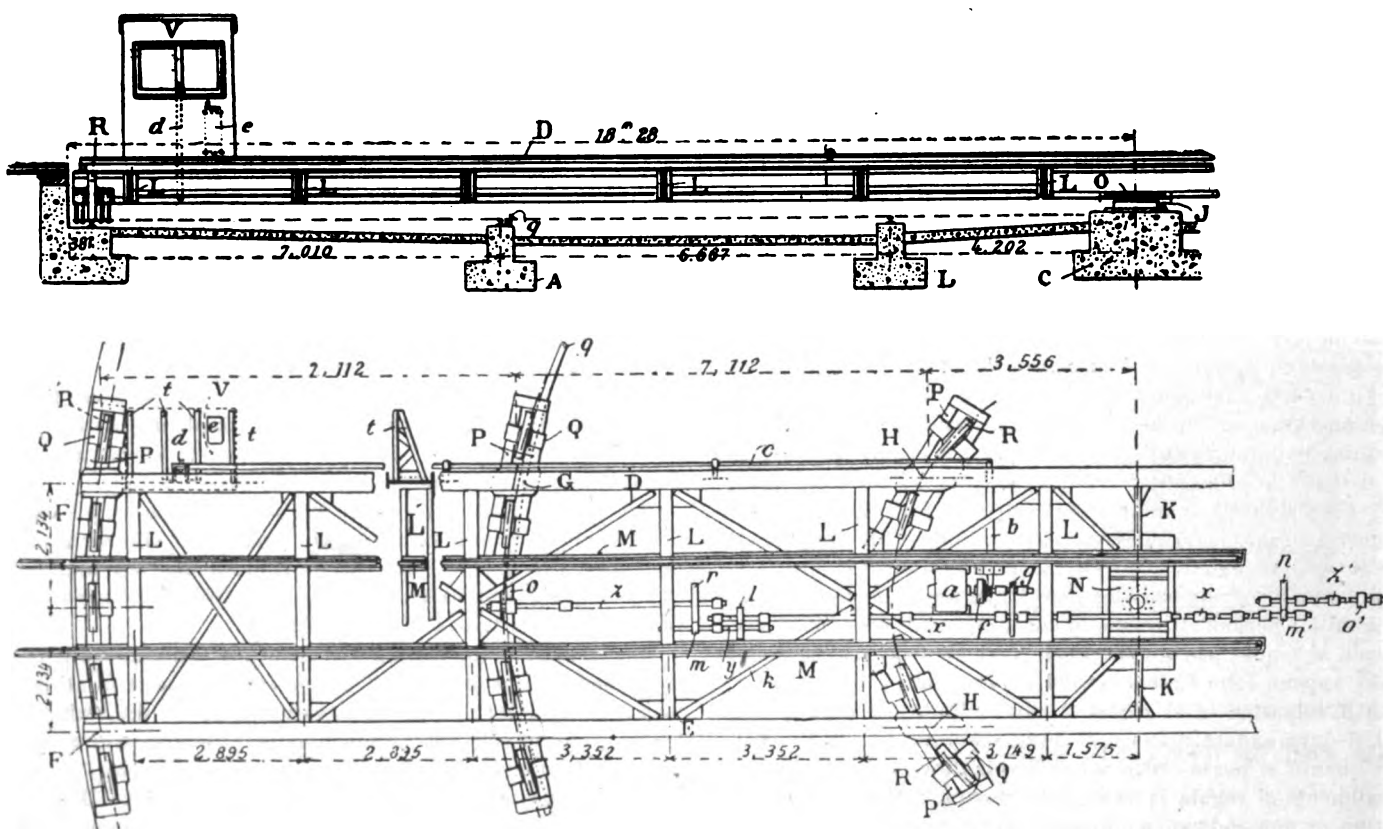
Piattaforma girevole da 36 m. per locomotive articolate Mallet. - Sezione e pianta.
